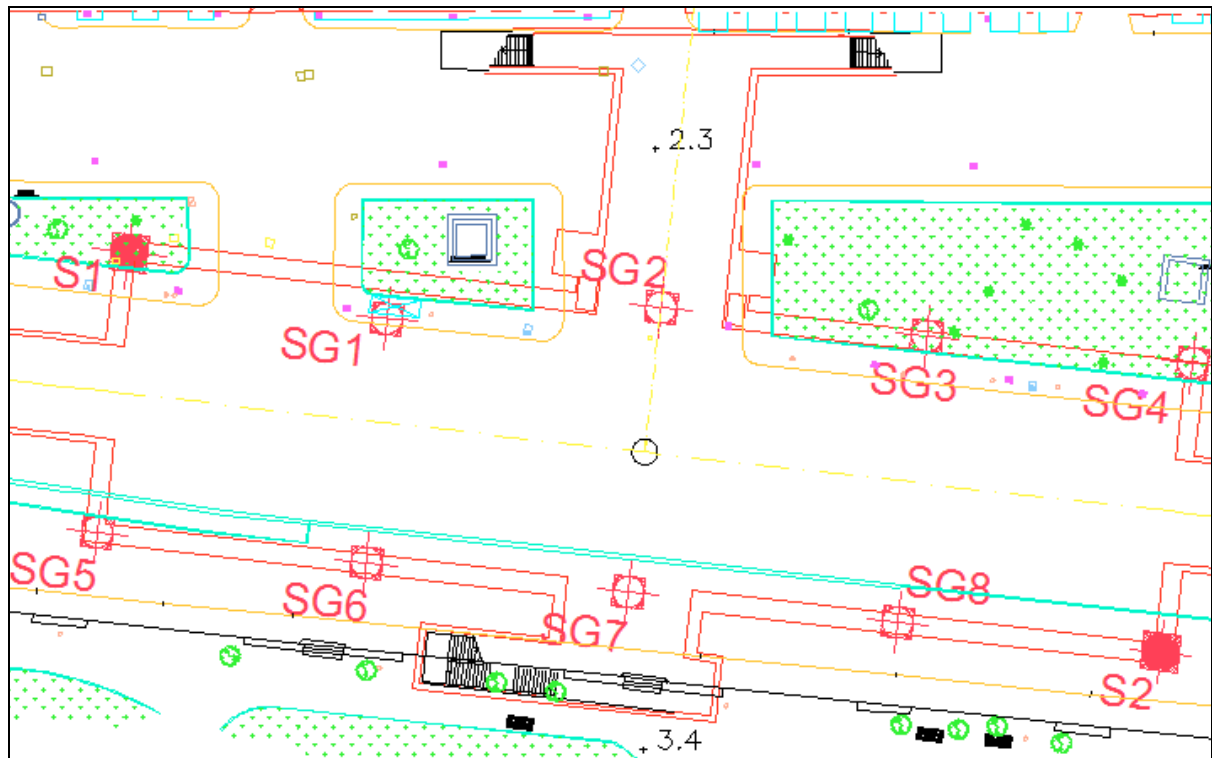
Posizione dei sondaggi rispetto alla pianta dello scavo principale
